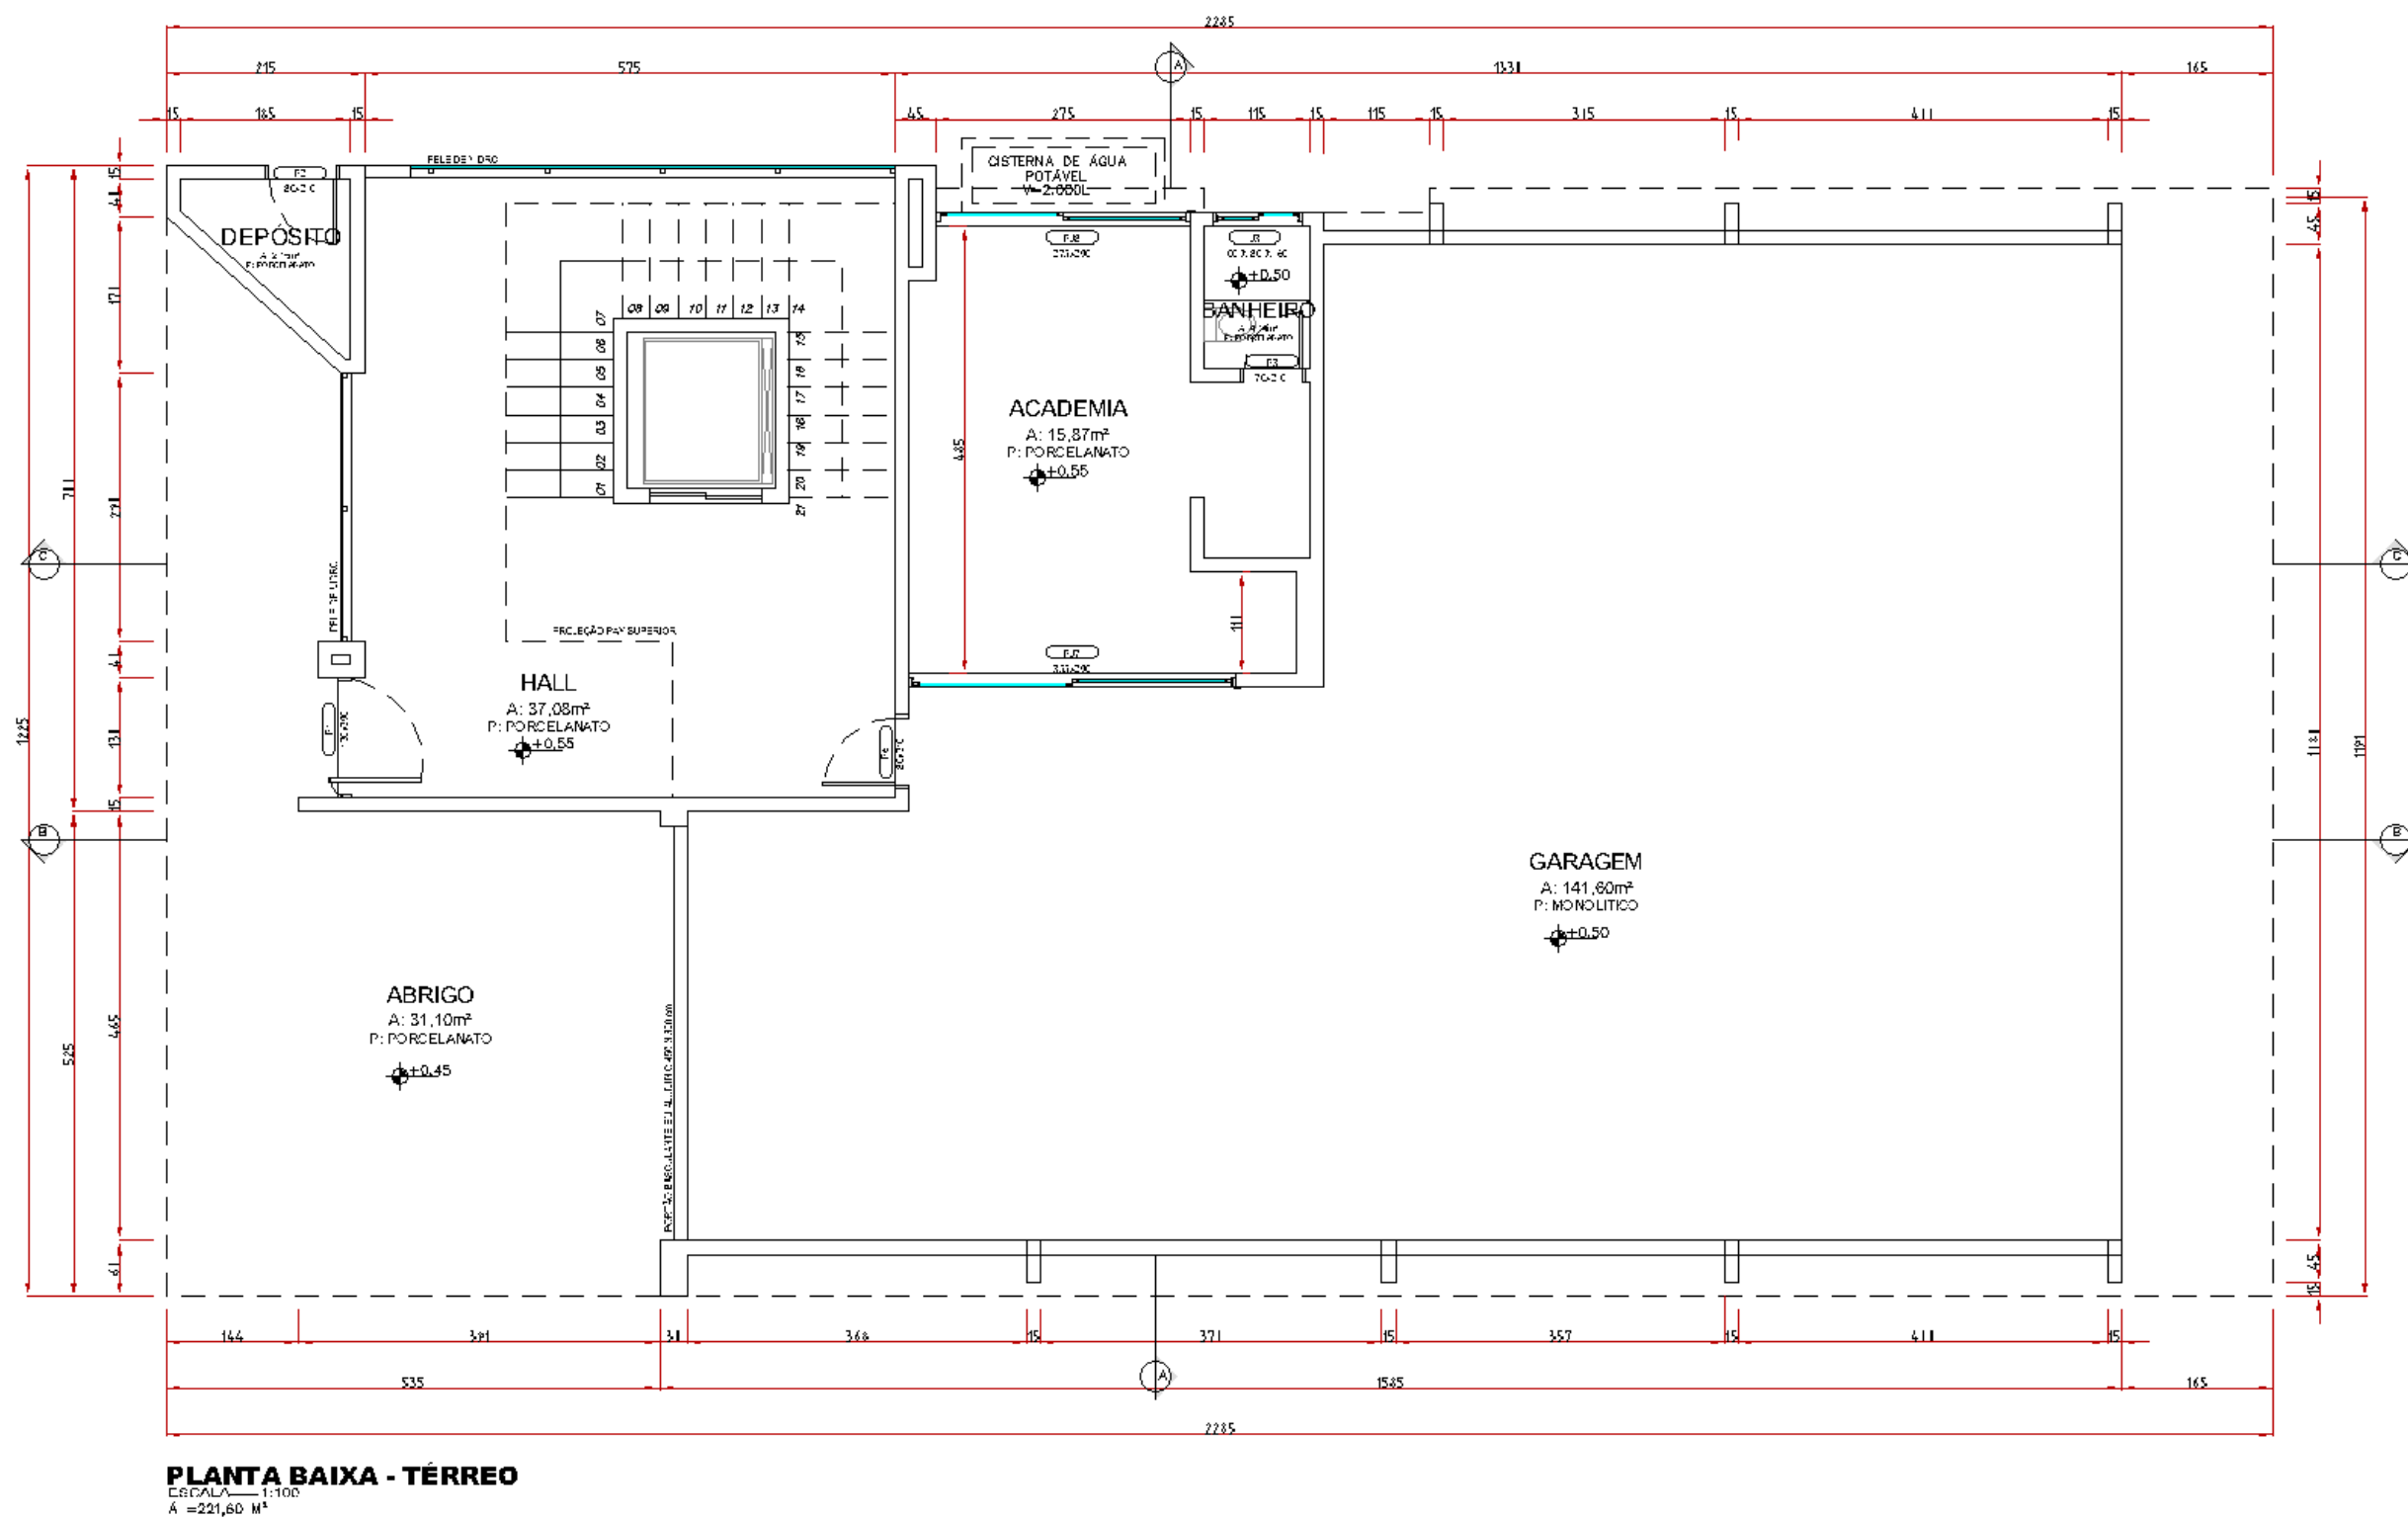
Planta Baixa pavimento Térreo. Fonte: Autor
